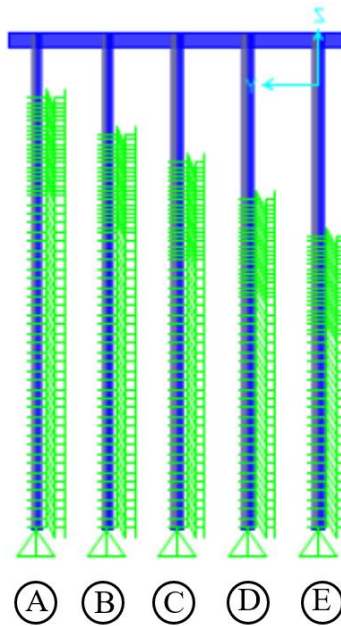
Vista elevación plano Y-Z muelle transparente con resortes
